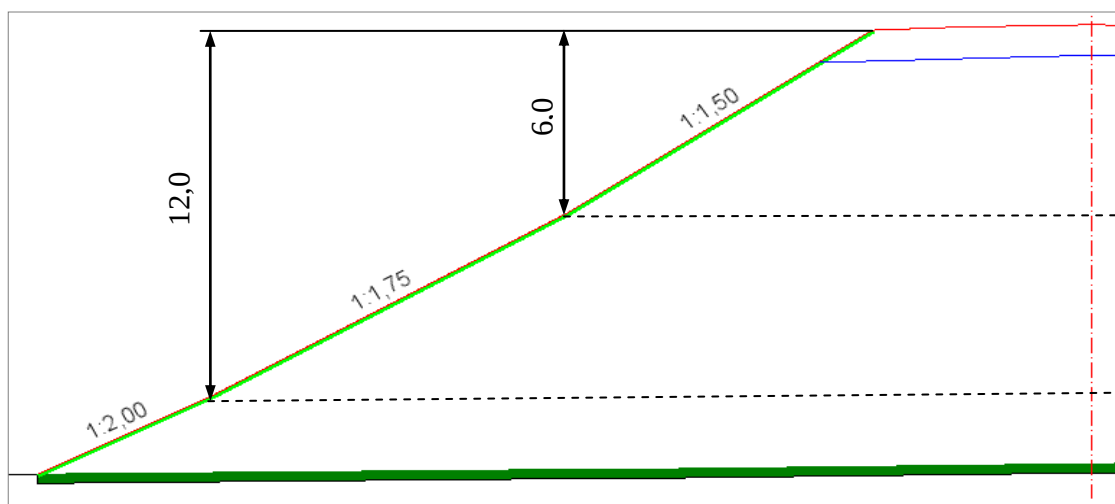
Стил Насыпь. Откос насыпи при высоте > 12 м
